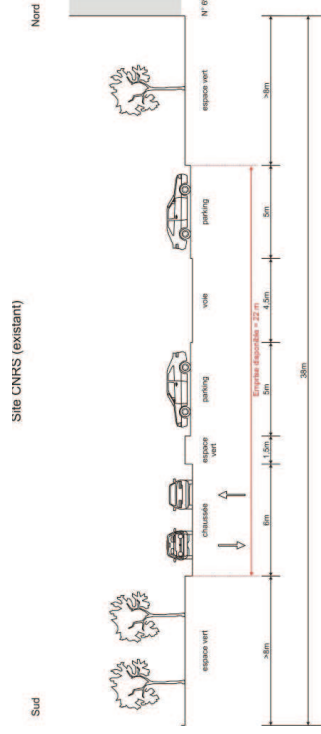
situation existante. Coupe sur le site du CNRS (Variante1).
